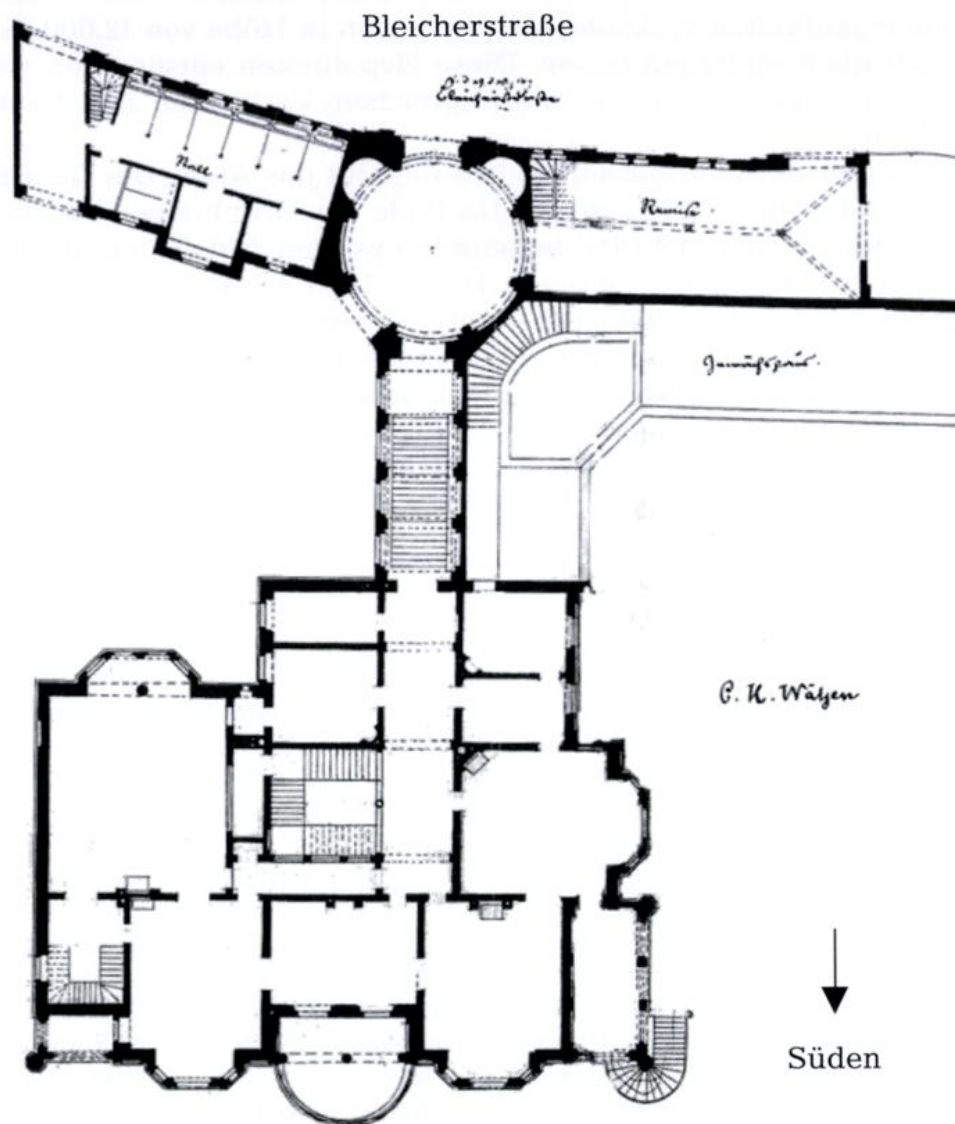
Grundriss des Hauses von C. H. Wätjen, Bleicherstraße 35, 1857.
